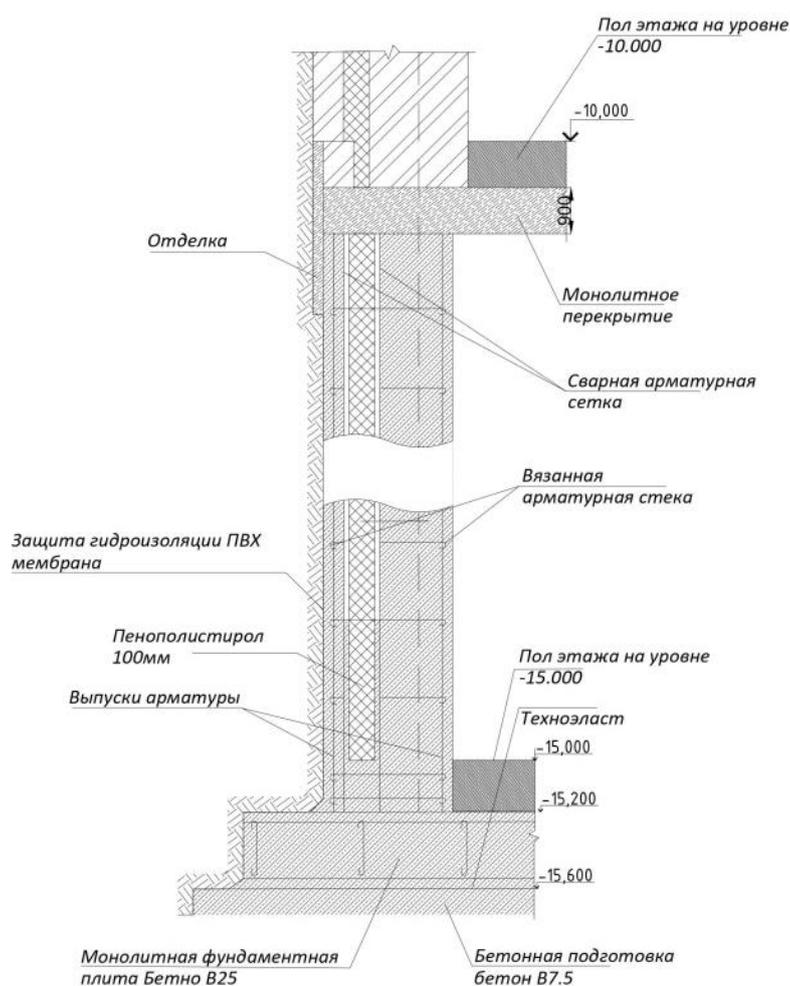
Узел фундамента с примыканием плиты перекрытия
